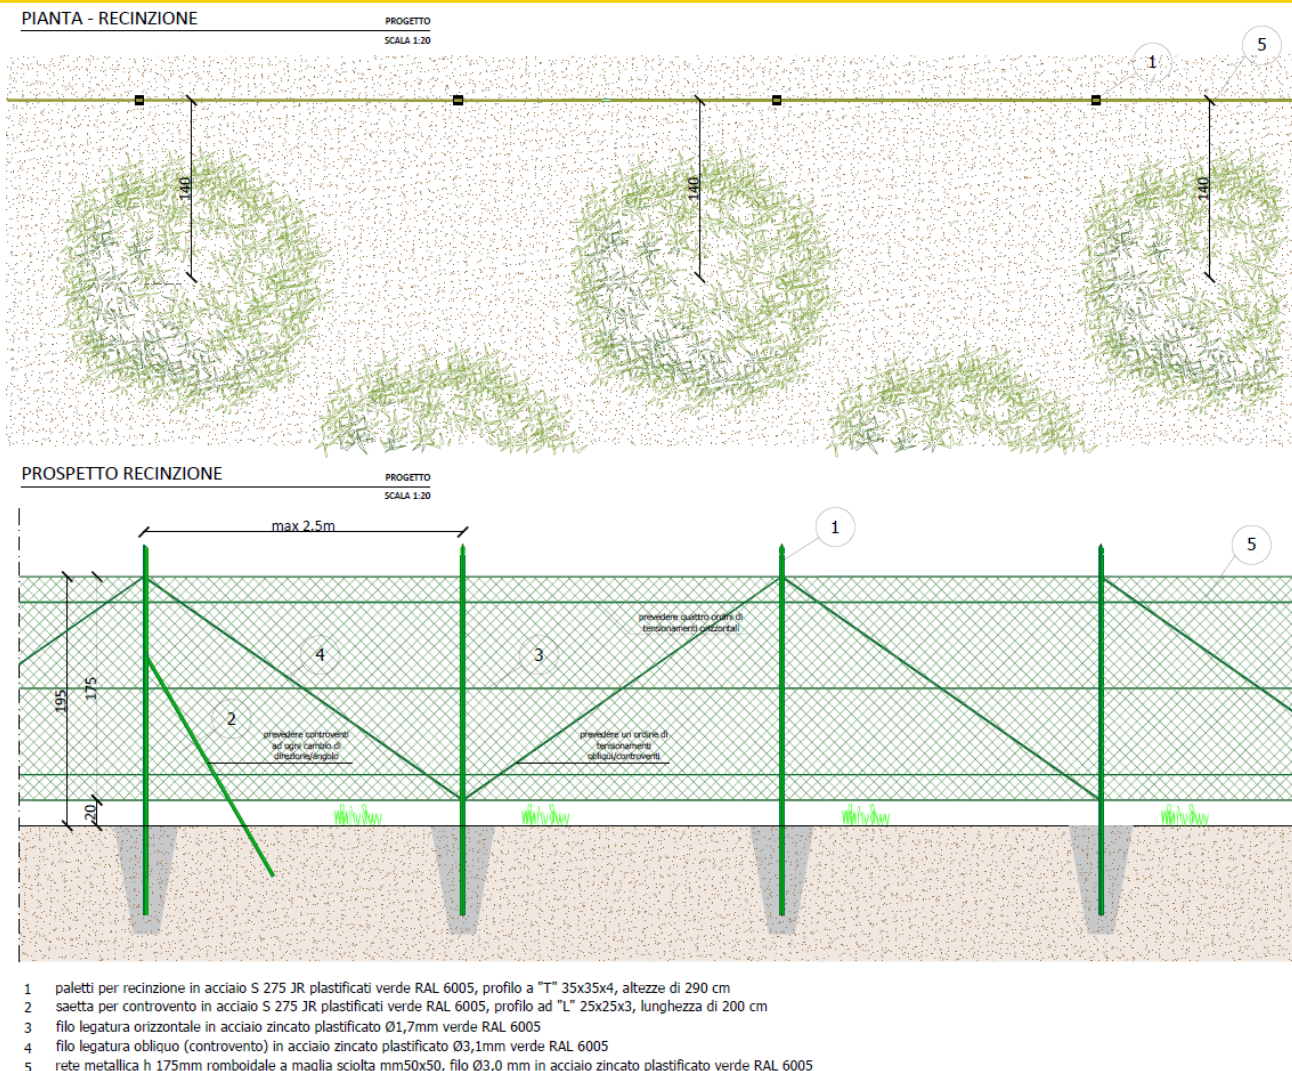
3- Disegno del prospetto della recinzione perimetrale di cantiere.
